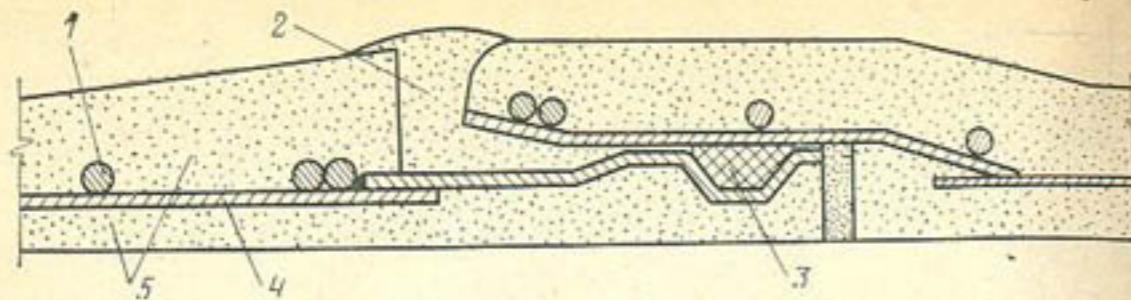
Соединение железобетонных напорных со стальным сердечником труб:
